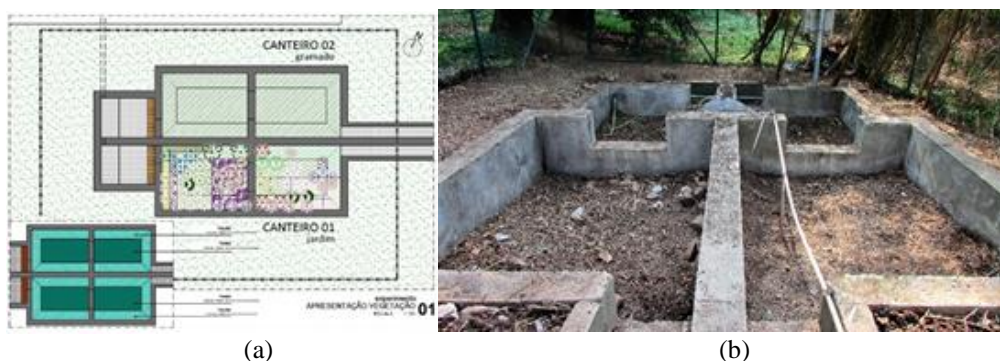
Estruturas (a) desenho esquemático (b) estruturas após a limpeza. Fonte: Moura, 2014. Foto: autores
